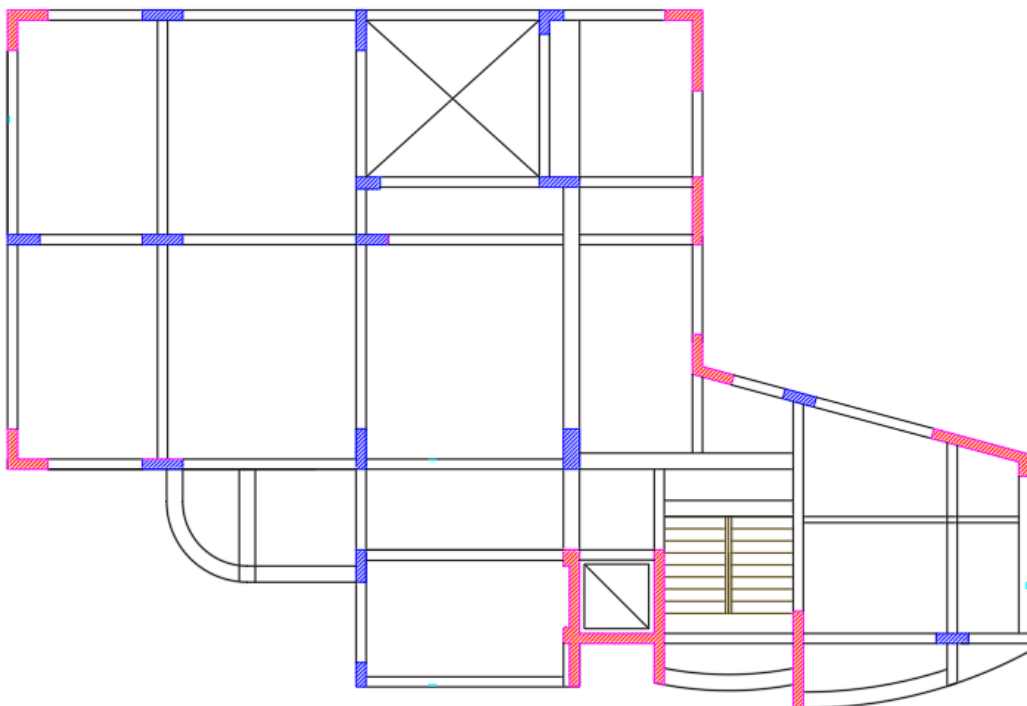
Distribución de elementos estructurales de la edificación- Piso 5
